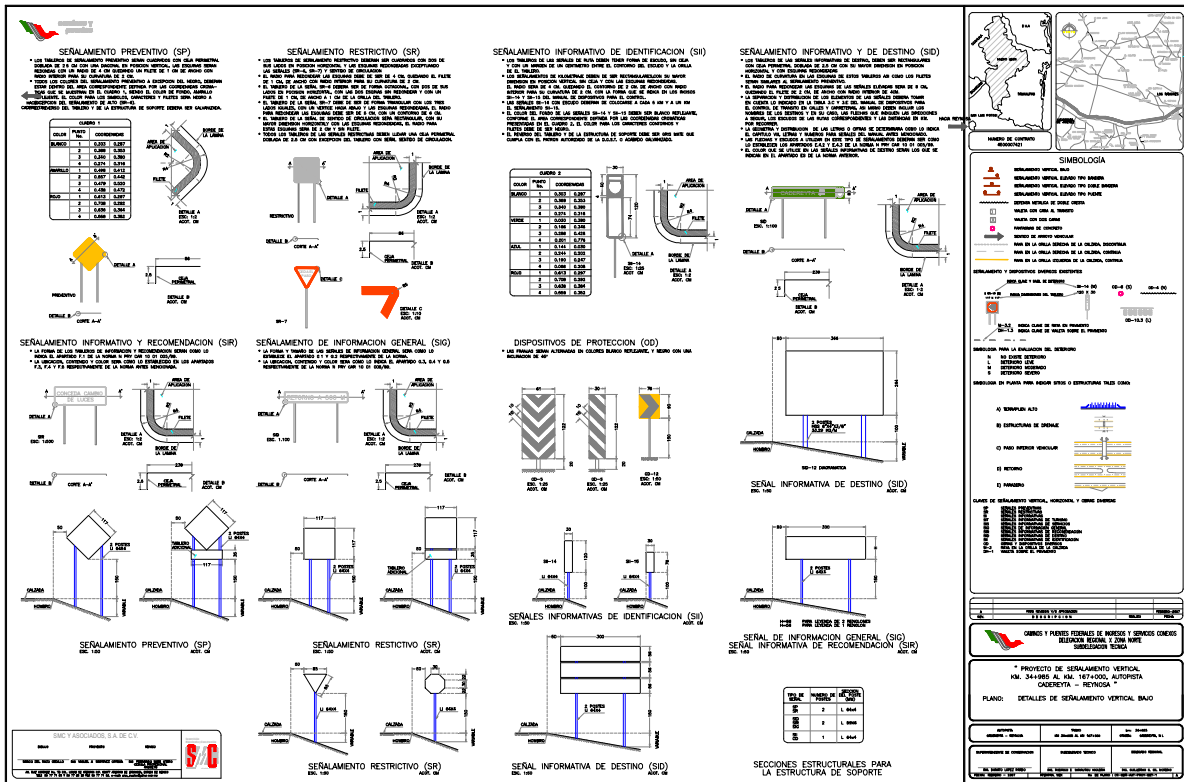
Ejemplo de plano de detalles del señalamiento vertical de proyecto en la Autopista 40D.
